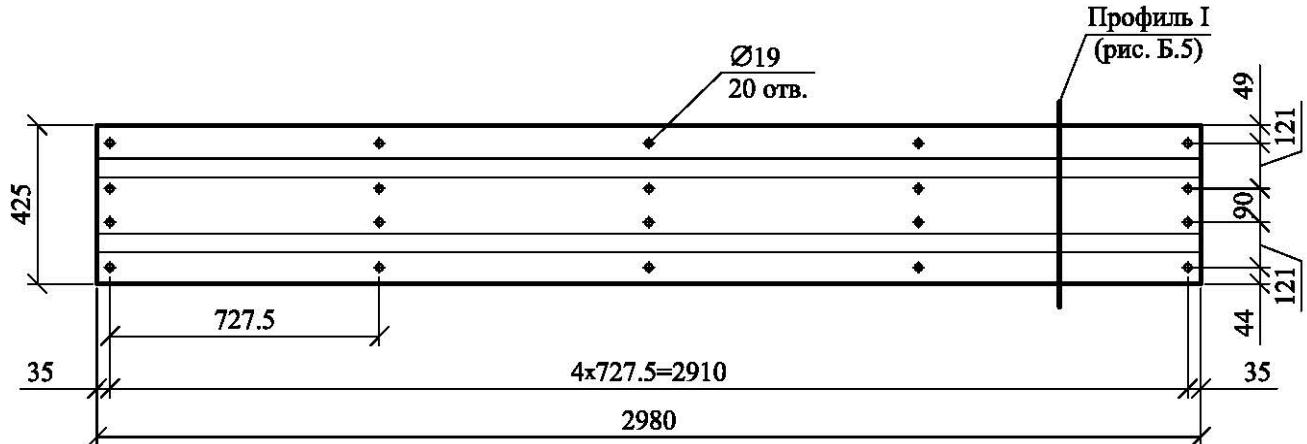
Ригель стенки из профиля КП. Вид и размеры
